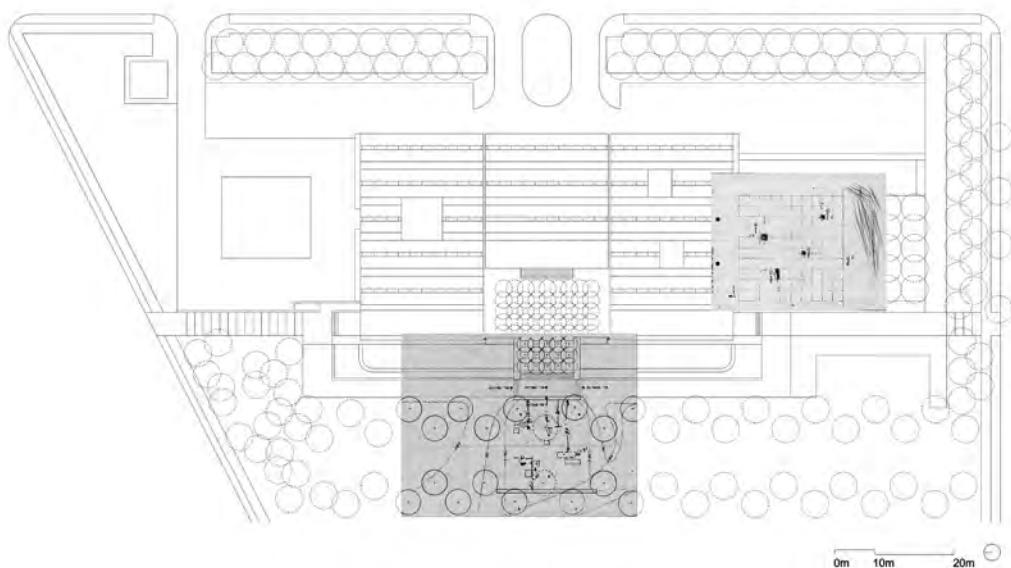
Fotomontaje sobre la planta del Museo Kimbell de las plantas de las dos ubicaciones de la obra *Constellation*. Imagen de los autores.
